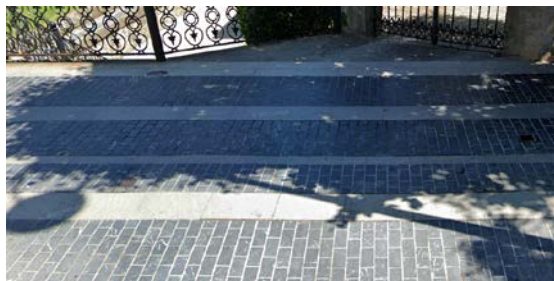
Sección de firme en cruces de zanja de la carretera N-634
